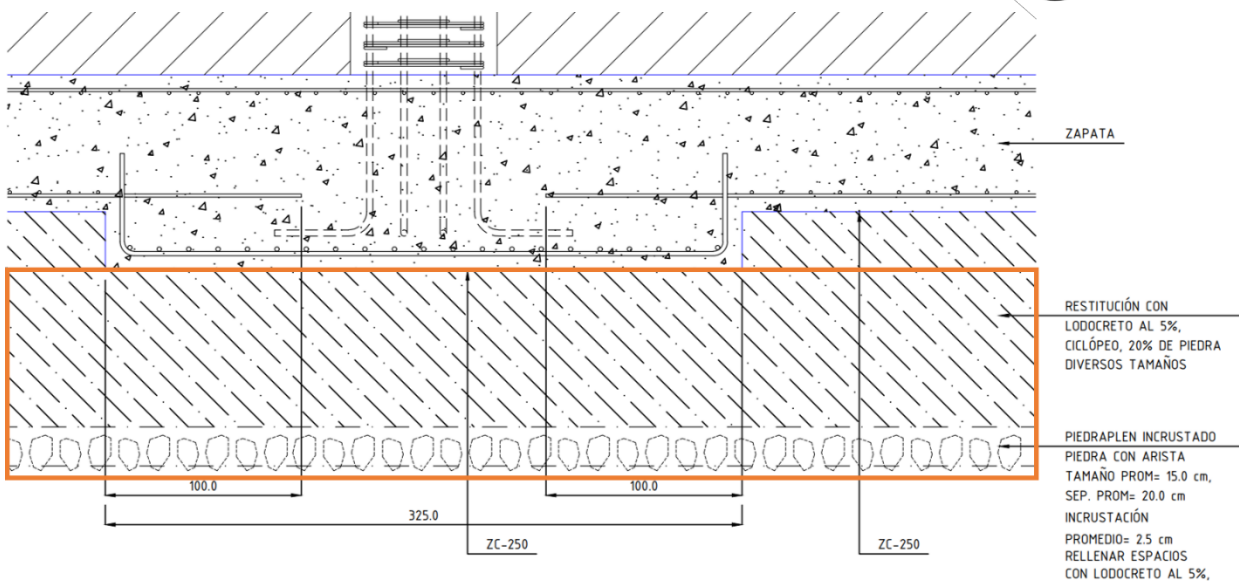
Detalle de composición de zapata corrida ZC-250 a colar.
